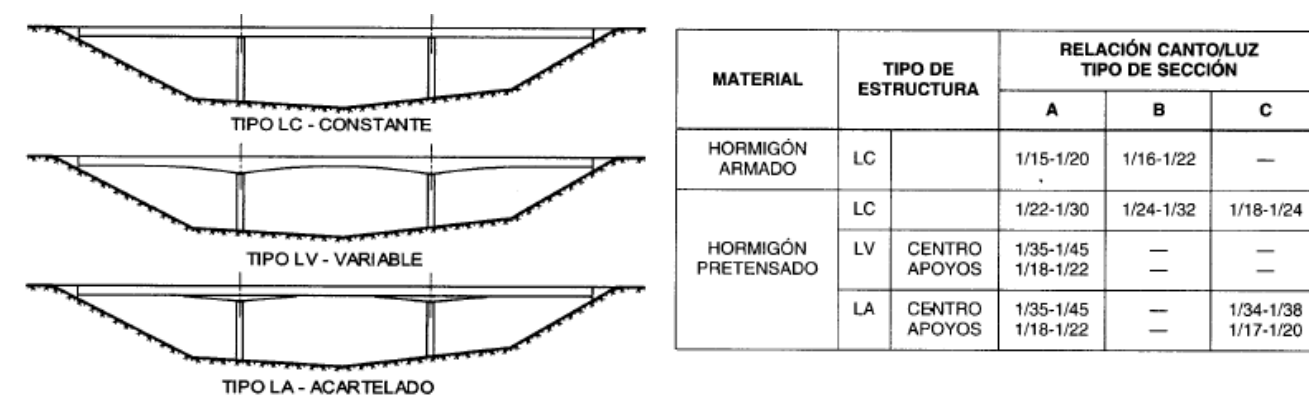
Distribución longitudinal puentes losa. Esbelteces
